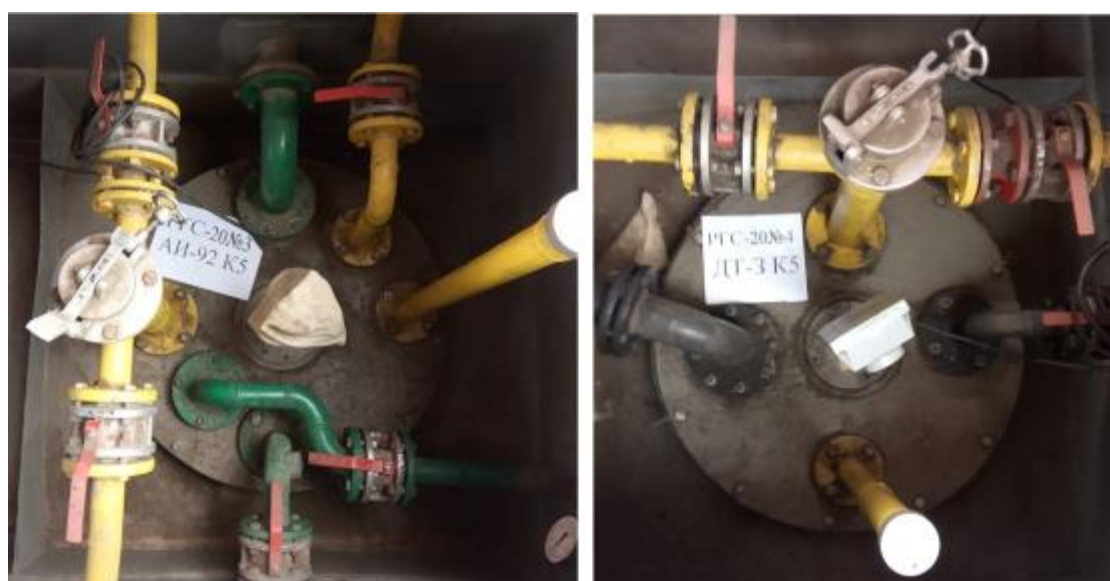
Горловины резервуаров РТС-20 зав.№№ 3, 4
